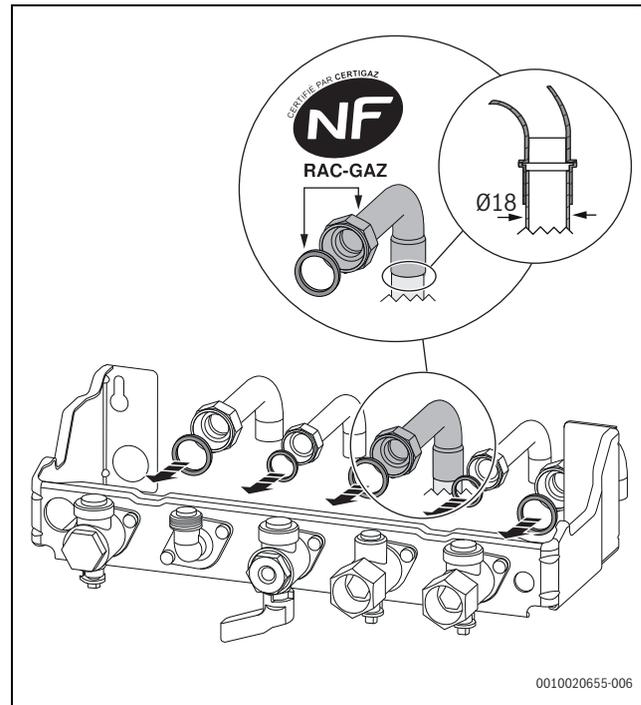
Montage des tubes avec les joints sur la plaque de montage pour le raccordement
